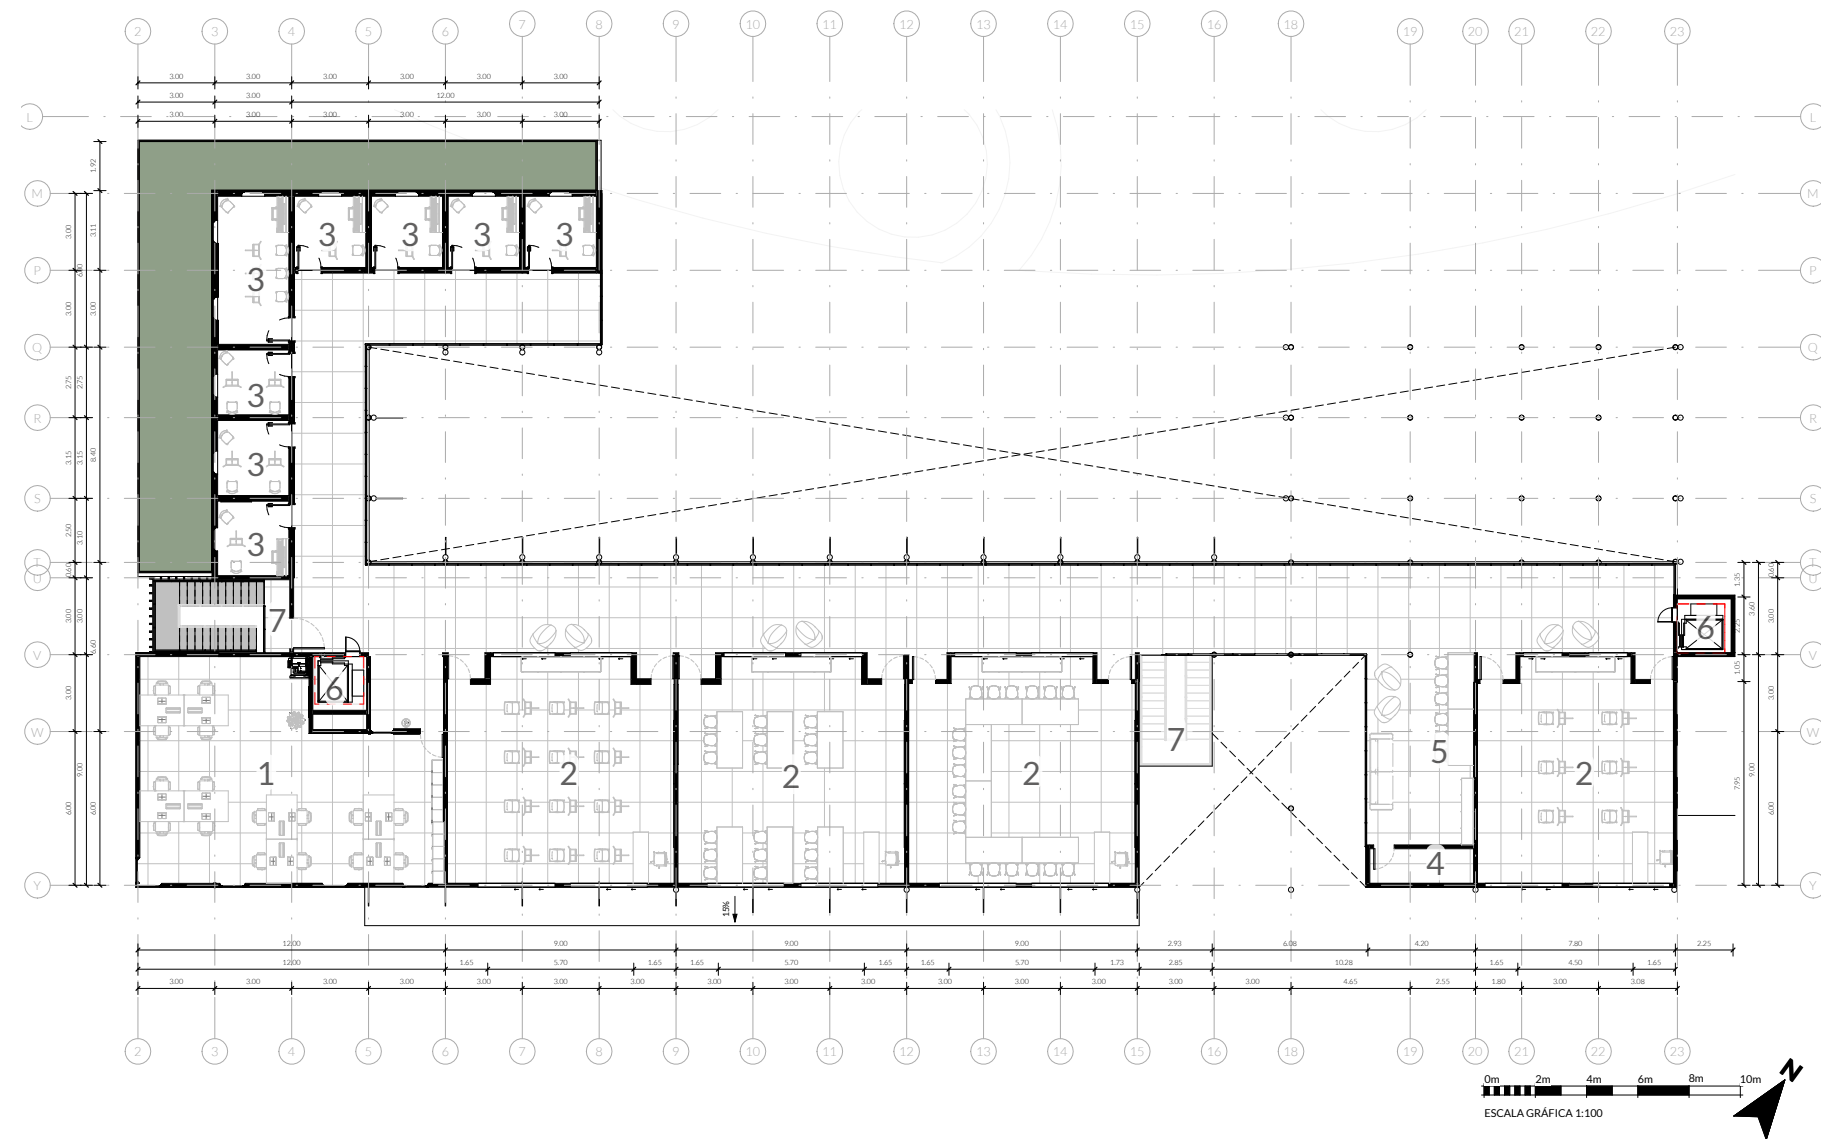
Distribución primer pabellón del segundo nivel del IAP. Elaboración propia.
